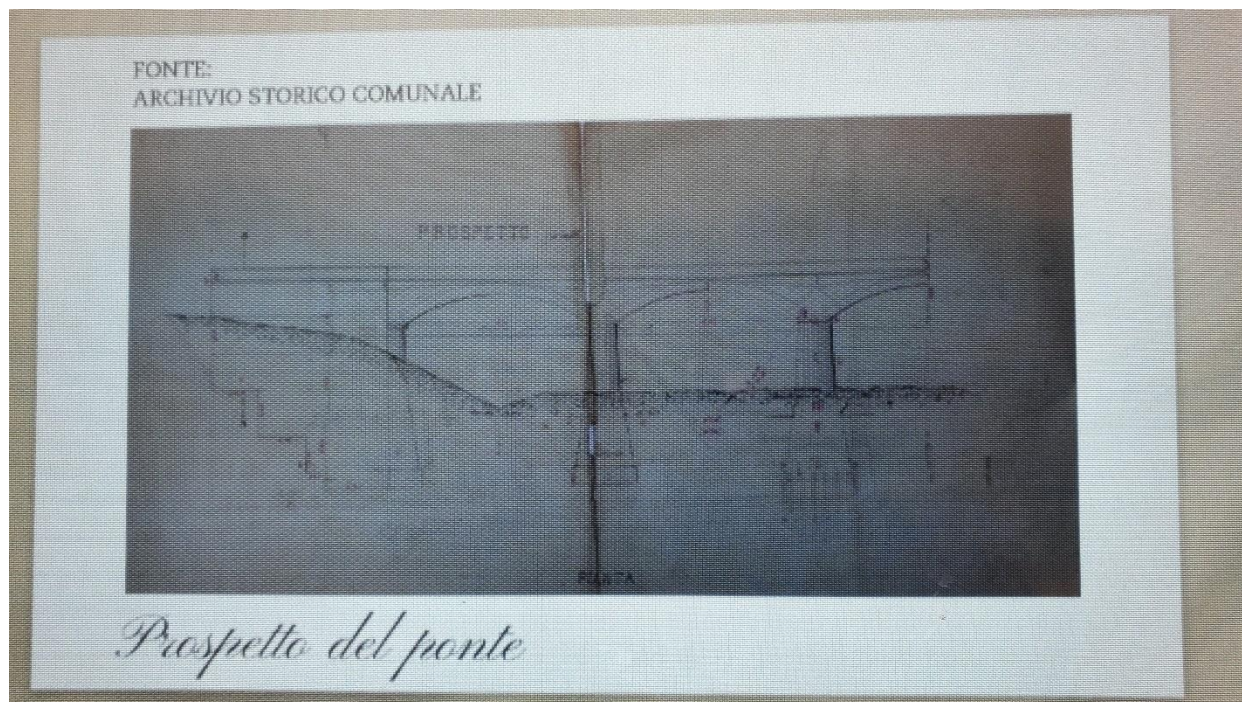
Foto archivio storico. Prospetto ponte di Statto e pile in alveo.
